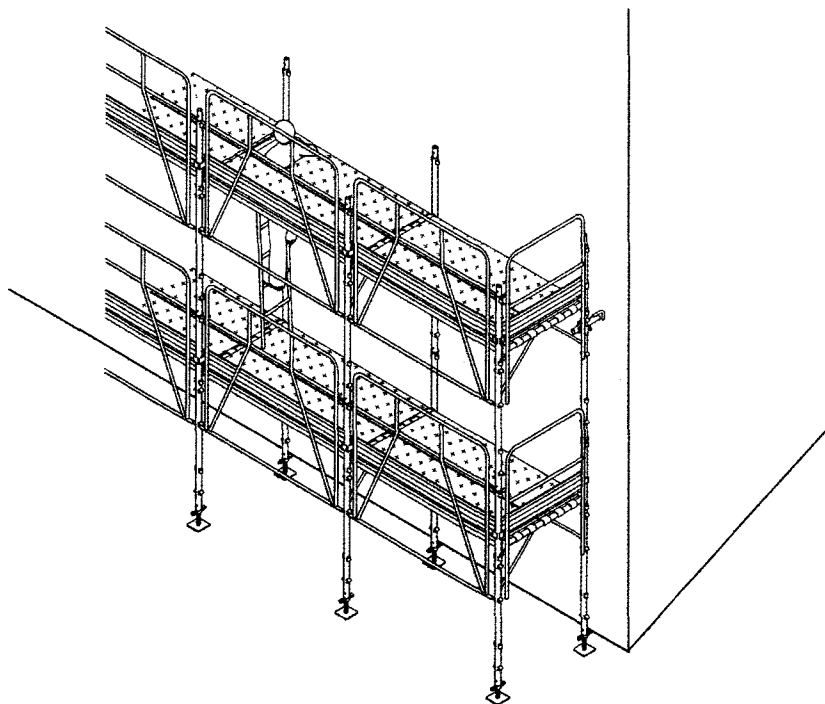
Fasi di montaggio dal basso del ponteggio con parapetto di protezione collettivo
